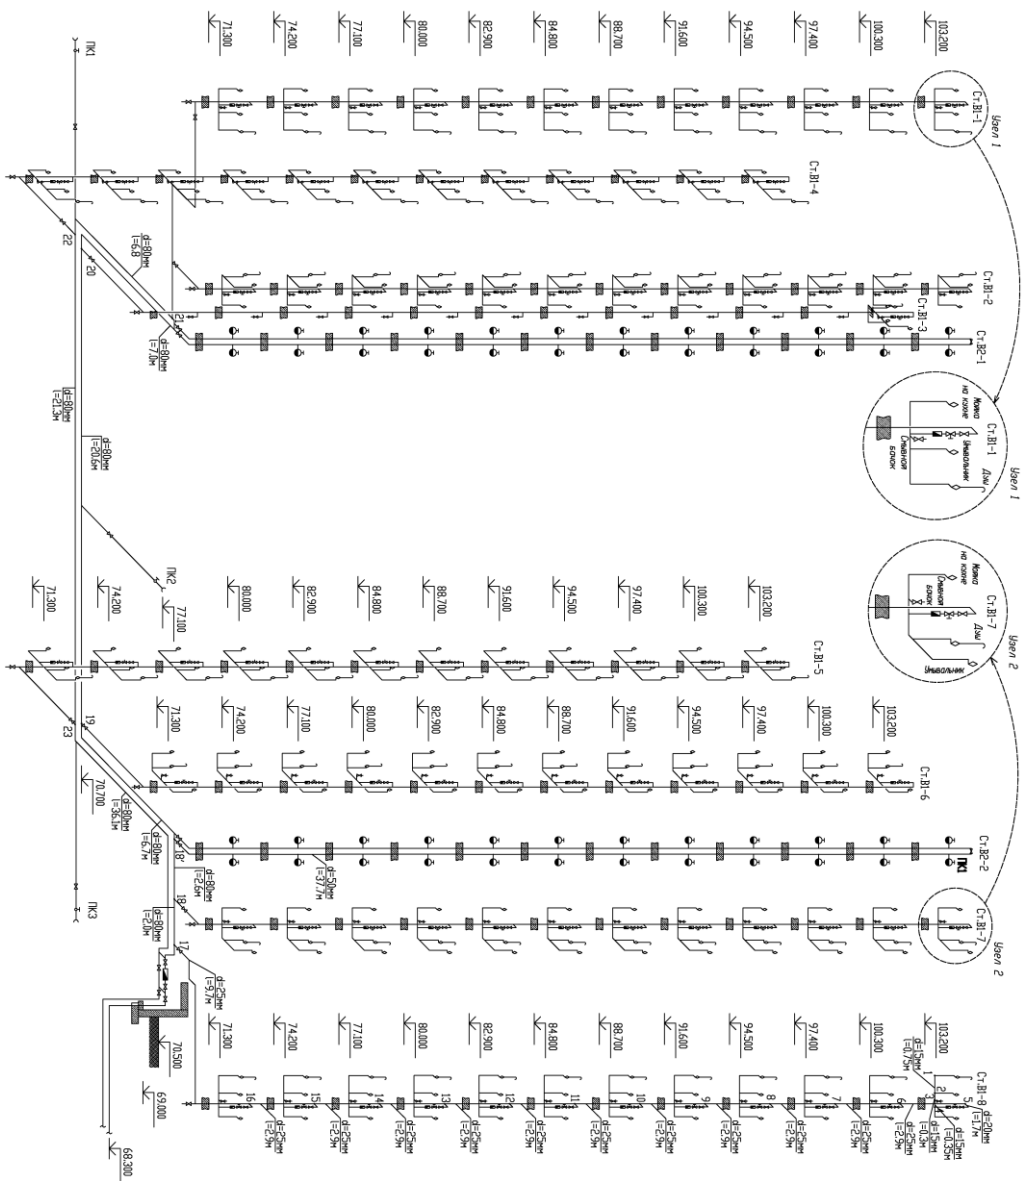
Аксонометрическая схема внутреннего водопровода (М 1:200)
